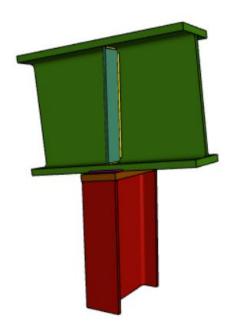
Unión pilares interiores pórtico posterior. Fuente: CYPE 2019
